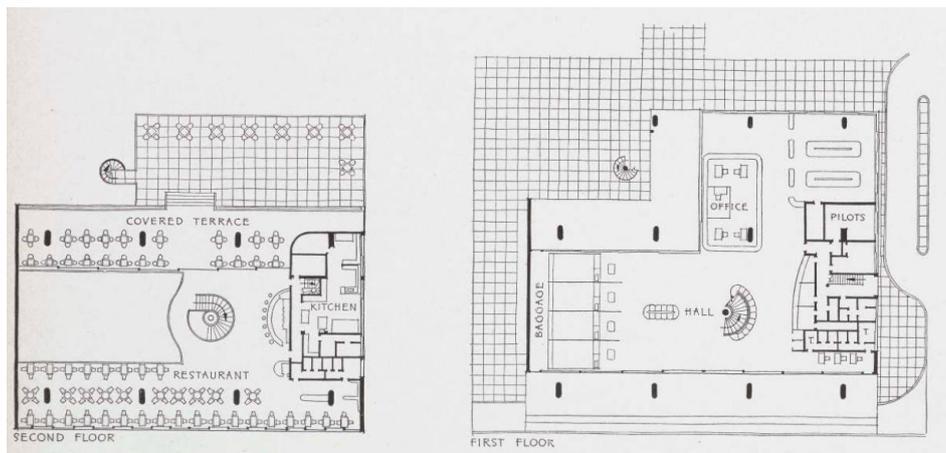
Planta Térreo e Pavimento Superior Estação de Hidroaviões do Aeroporto Santos Dumont.
